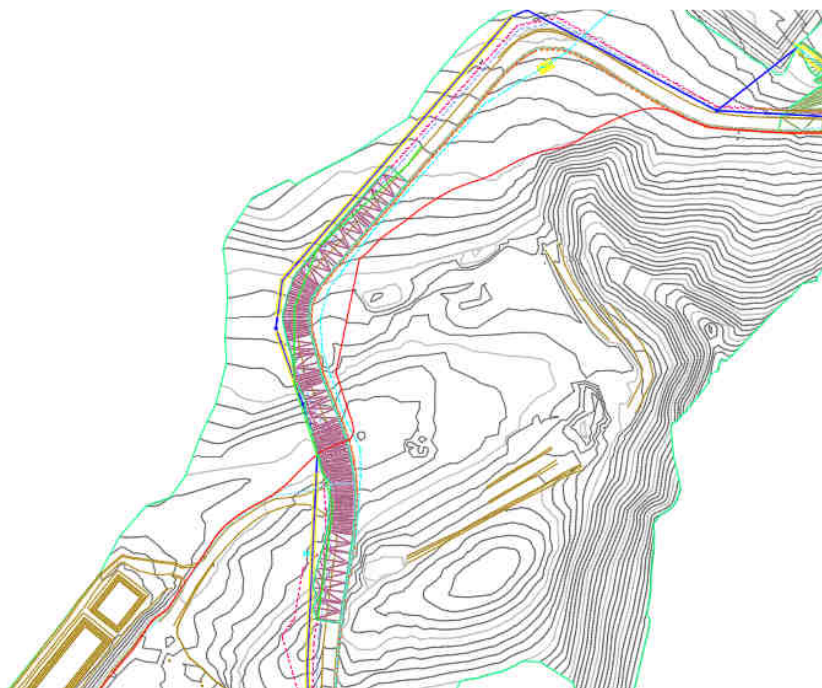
Diseño constructivo del sitio de obra Escombrera 2 del PG Borinquen.
